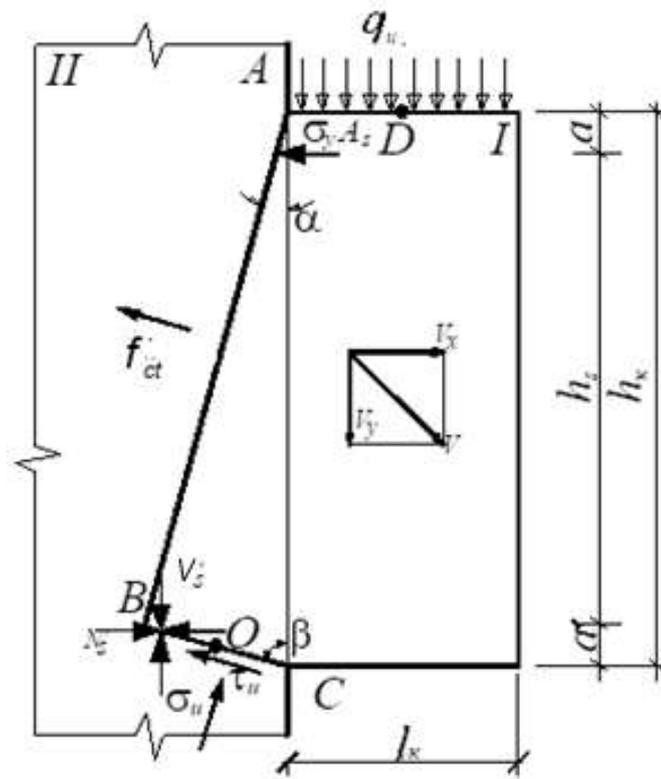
Кінематично можлива схема руйнування прямокутних залізобетонних шпонок при зрізі у разі розташування арматури в два яруси та врахуванні нагельного ефекту в арматурі, котра розташована у стиснутій зоні
